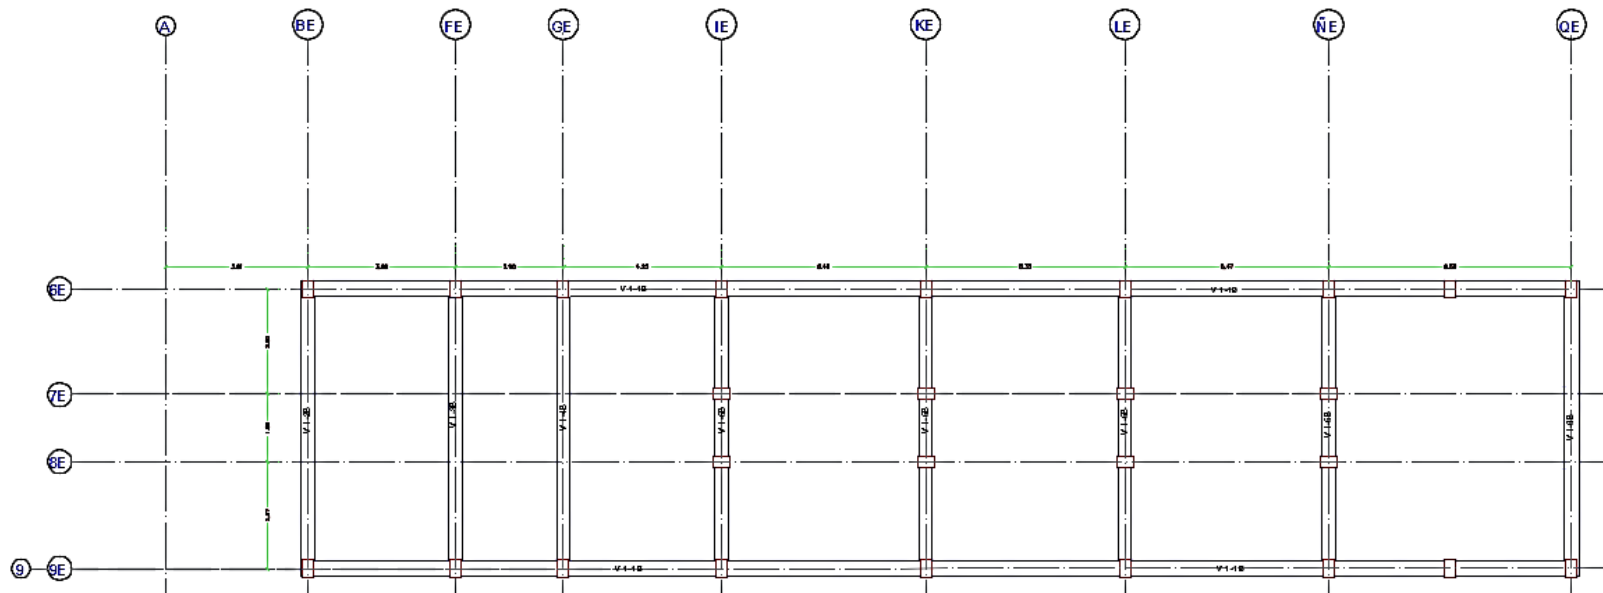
Planta estructural zona B, nivel 3.45 m. Fuente: Autor.
